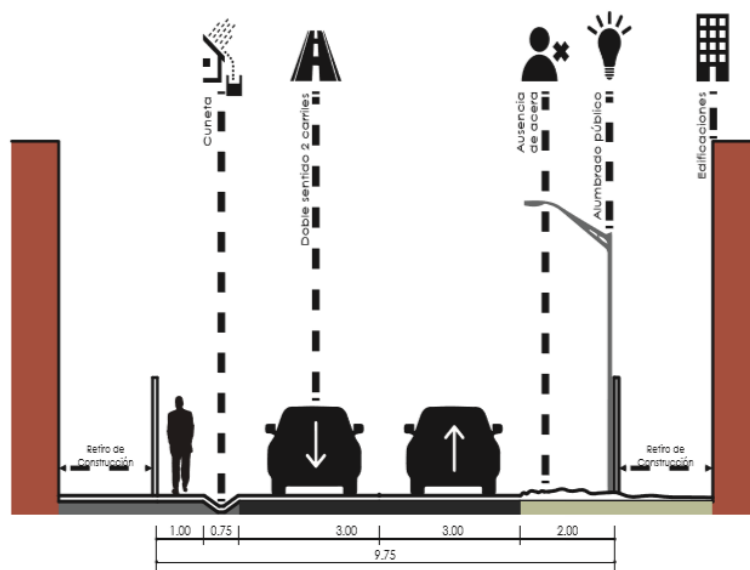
Sección transversal de calle Cocha, lindero norte del terreno de intervención.
